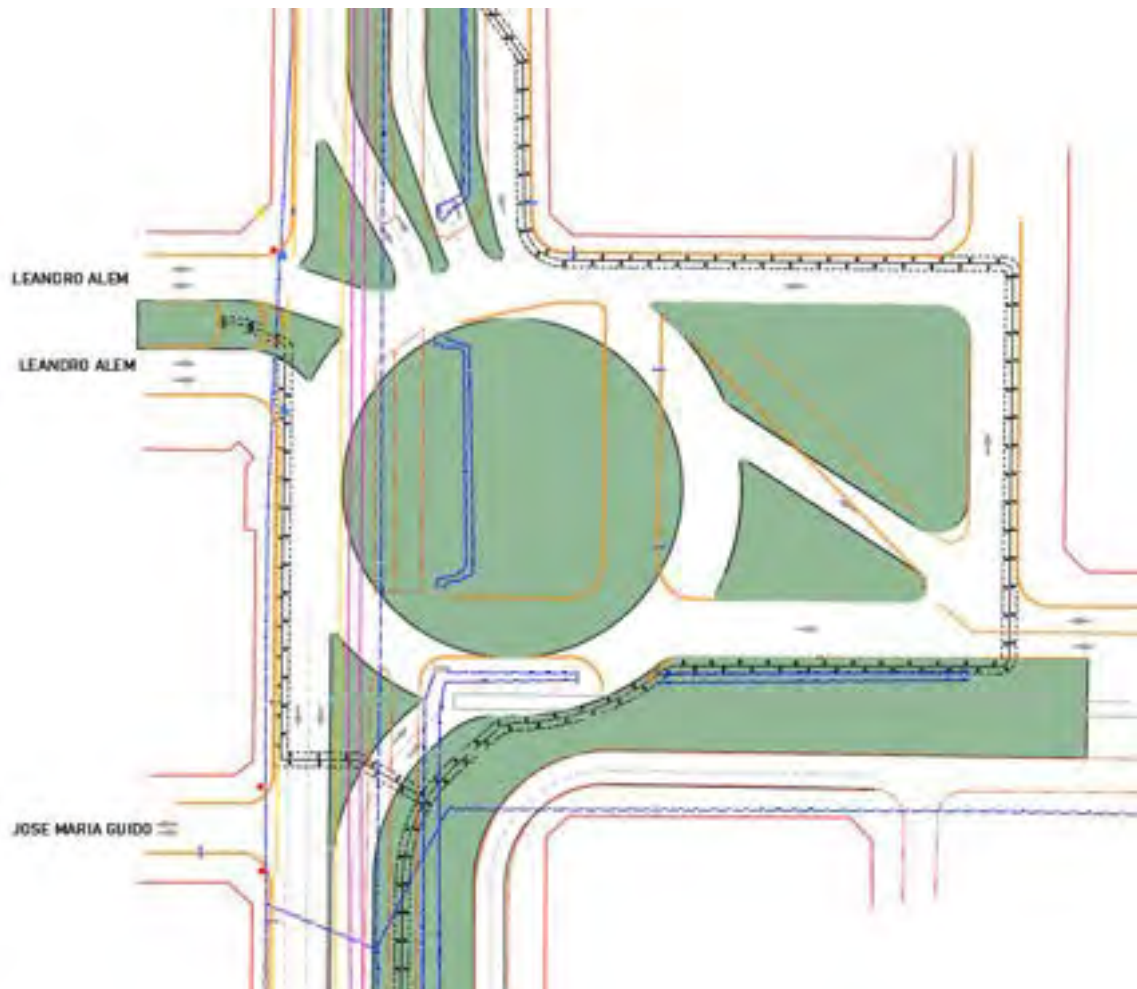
Intersección con calle Leandro Alem (Fuente: elaboración del equipo de ingeniería)
